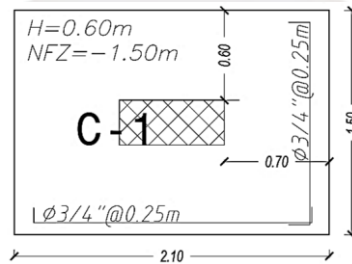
Diseño final de la zapata aislada en el eje A-3
